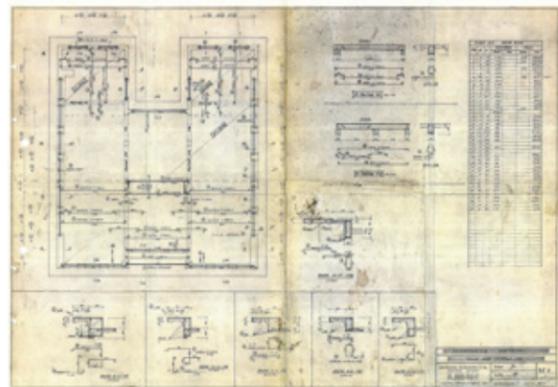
Exemple d'ancien plan as-built (image d'illustration)
